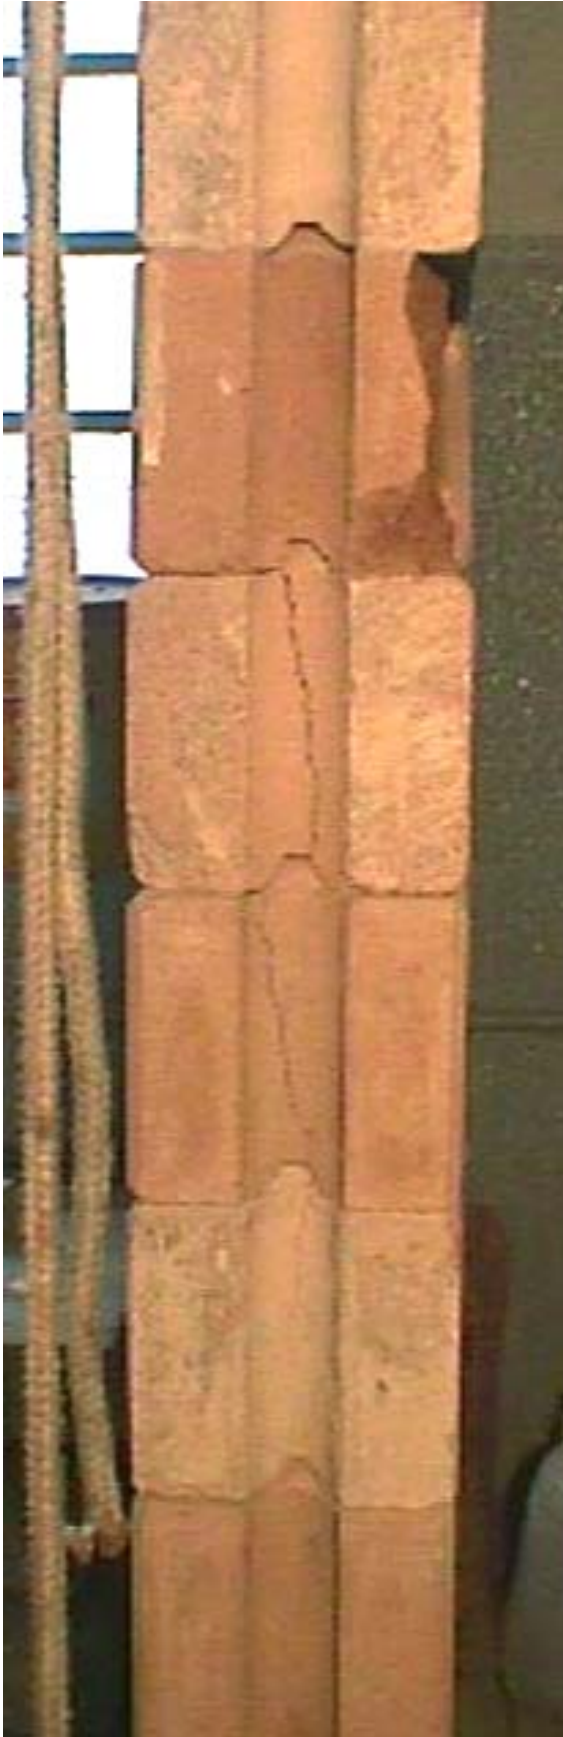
Detalhe da ruptura da face leste da parede P1 com 20 fiadas. Observa-se a ruptura do septo central e esmagamento local em um TJ 101
